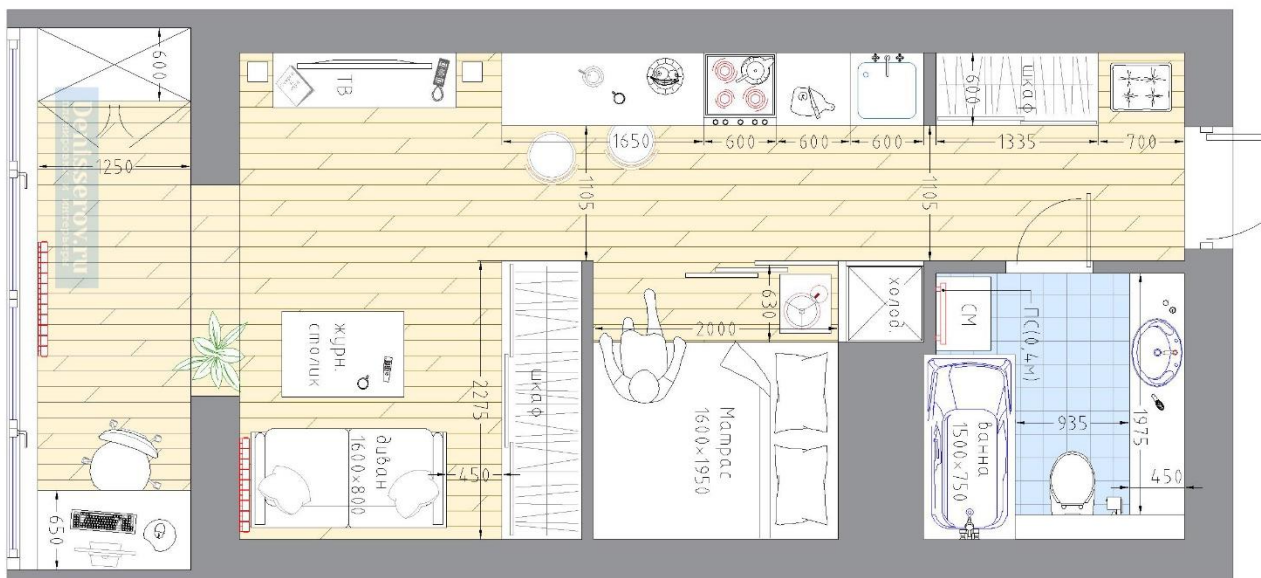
Планировка студии площадью 30 м<sup>2</sup> без отдельной спальни
